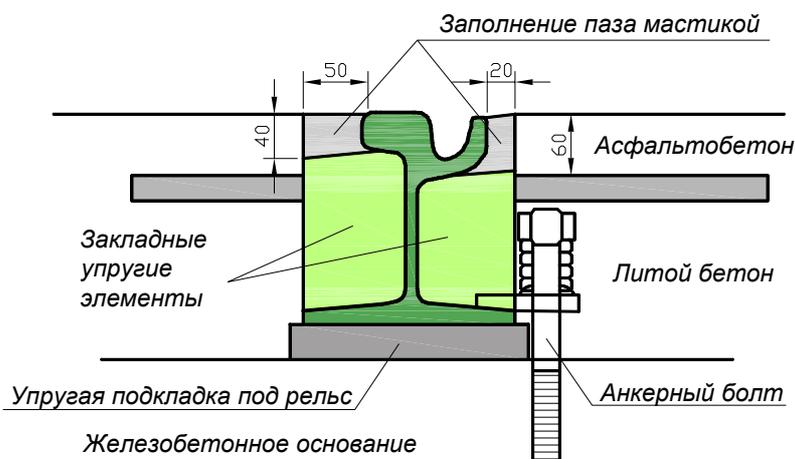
Схема монтажа рельс на железобетонное основание
